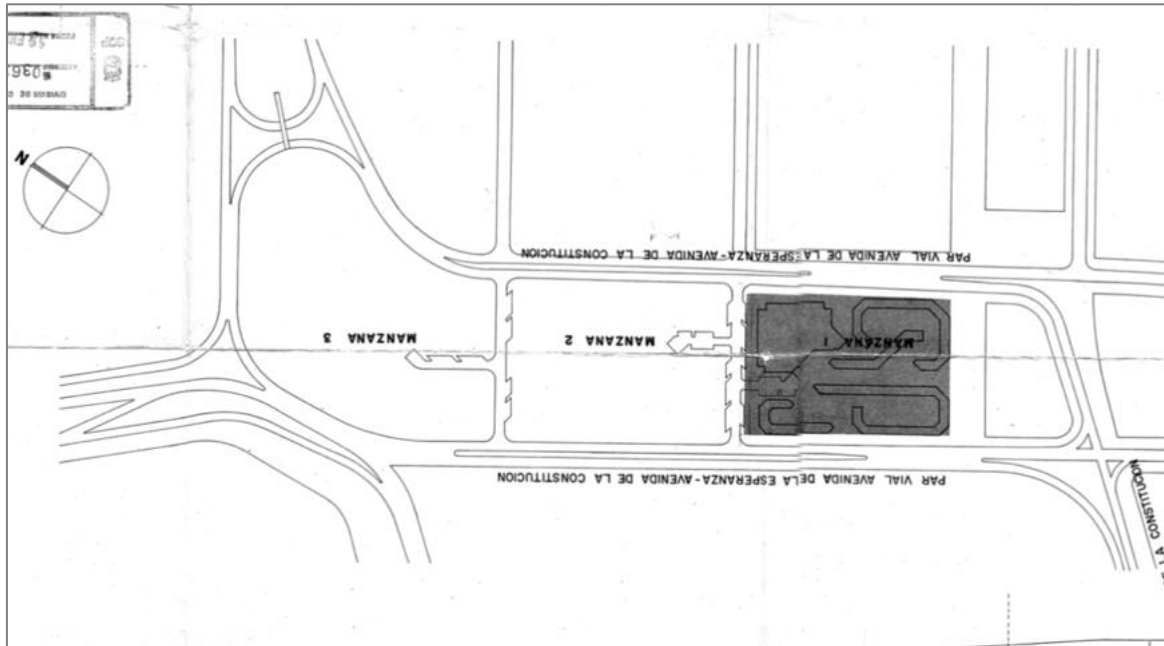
Planta de Localización Conjunto Residencial Alcaparros de Sauzalito. Fuente: (Archivo Distrital de planiación)
